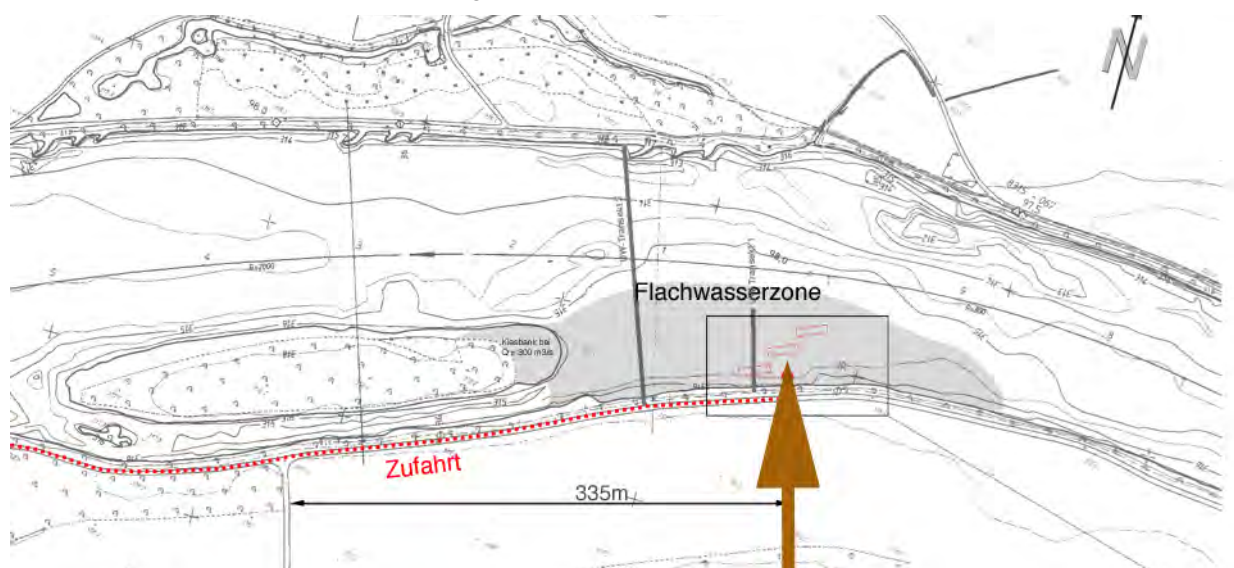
Lage der Schüttstelle Riethelm im Bereich der bestehenden Flachwasserzone mit geringer Strömungsbeanspruchung. Massstab 1:5'000.
